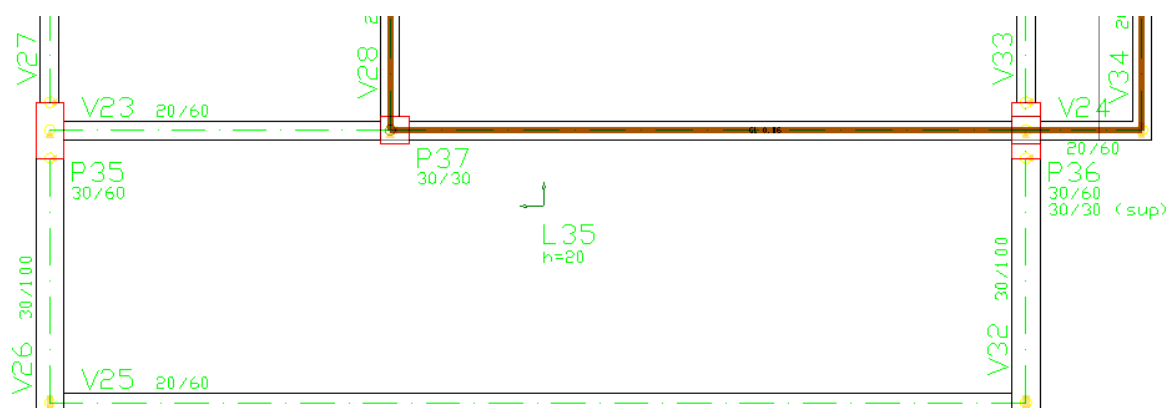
Pavimento Abrigo da Solução Convencional com as vigas V26 e V32 de menor comprimento
